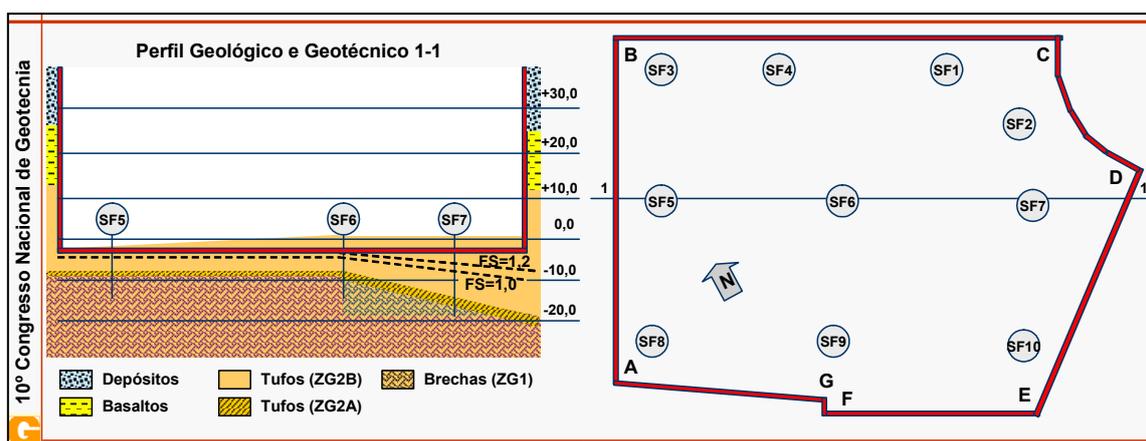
Perfil geológico e geotécnico e planta de localização das sondagens
